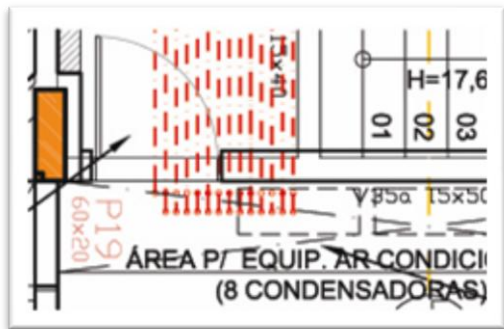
Planta baixa intersecção dos dutos de condicionamento de ar com esquadria.
